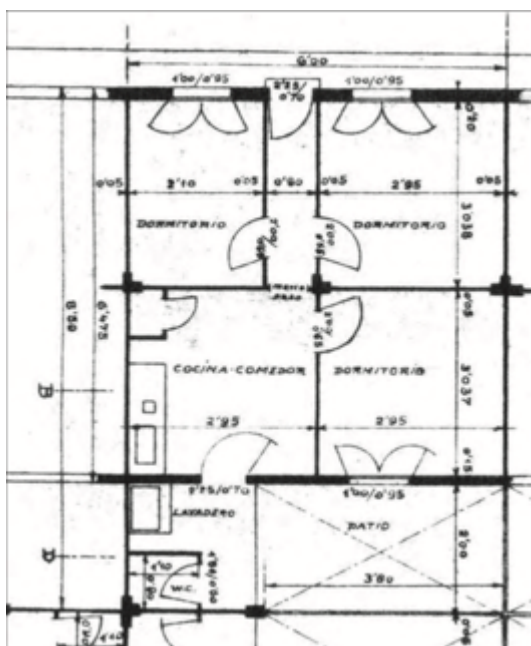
Planta de las casas baratas construidas al final: 38 m², un patio en vez de huerto y 3 dormitorios. Fuente: López, 2013.
